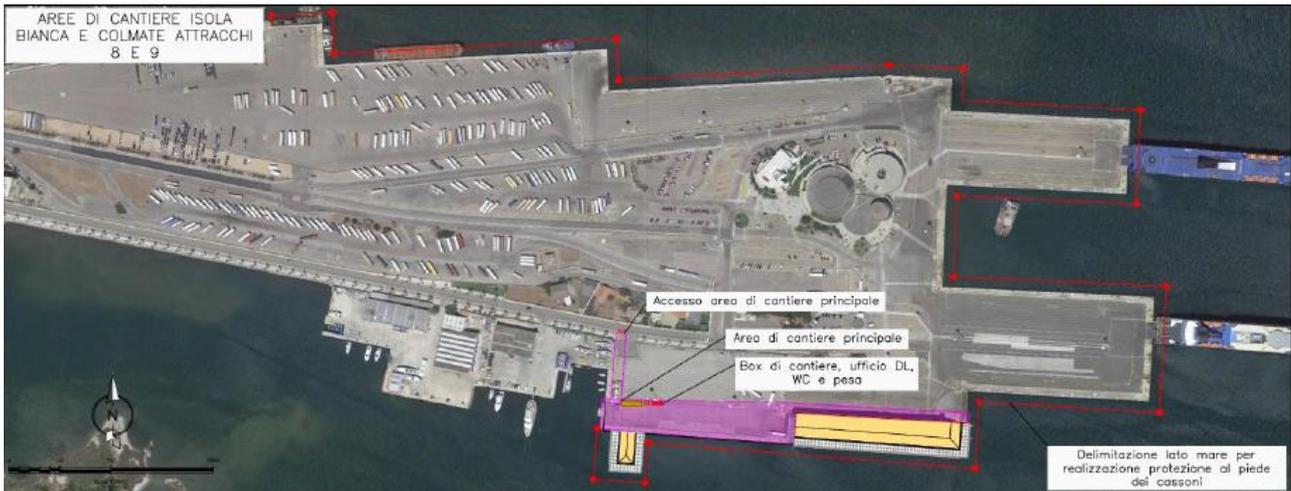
Area di cantiere Isola Bianca e colmate attracchi n.8 e 9
